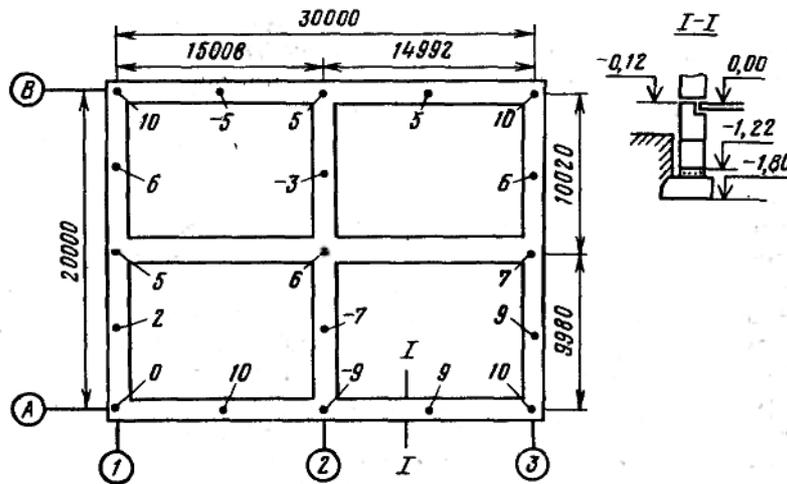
Исполнительная схема положения конструкций подвала
